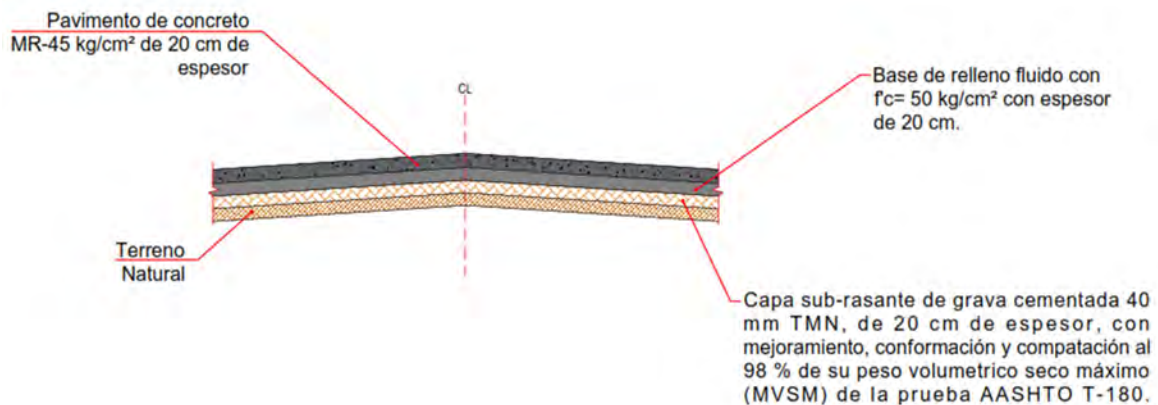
4 Sección de pavimento del proyecto de rehabilitación Calle Londres, identificando los espesores y características de materiales y conformación de las capas, sub-base, base y pavimento.
